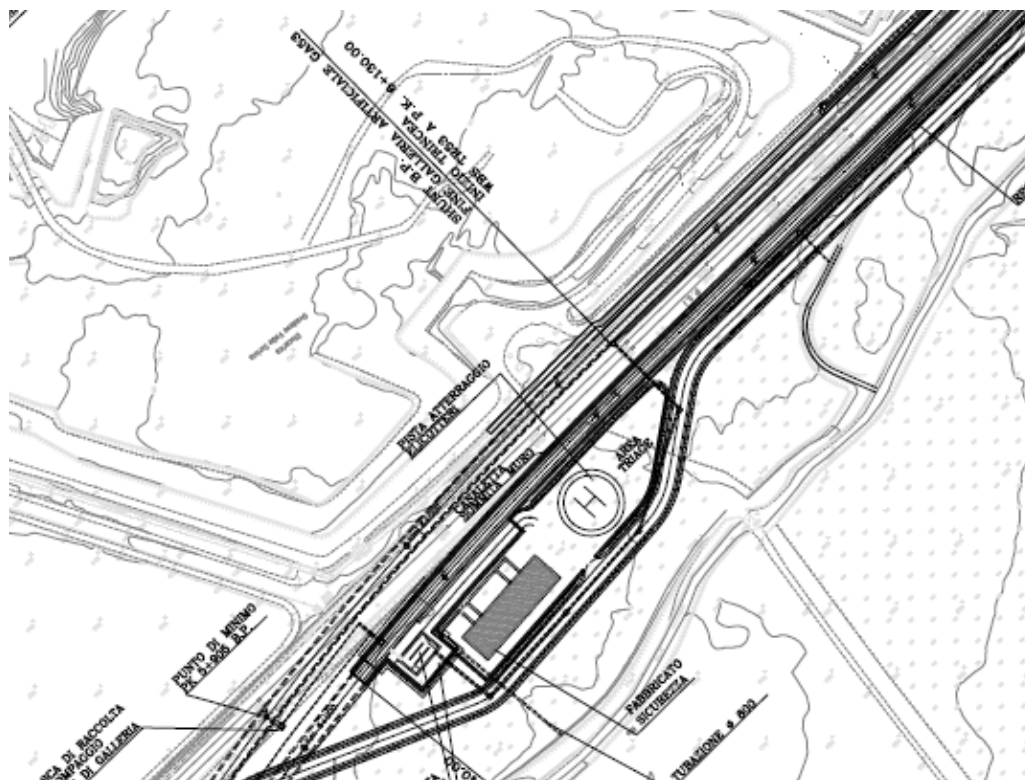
Planimetria piazzale di emergenza imbocco Shunt nord
